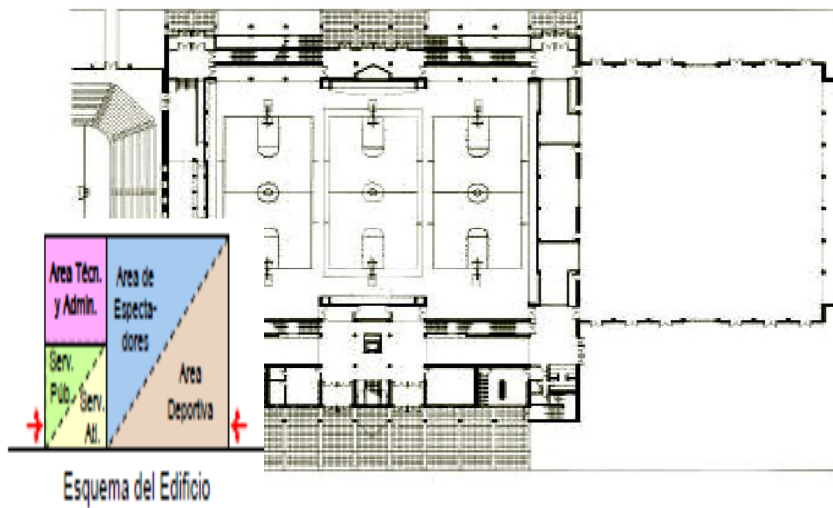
Primera planta basketball arena and field house Ithaca, NY, eau
